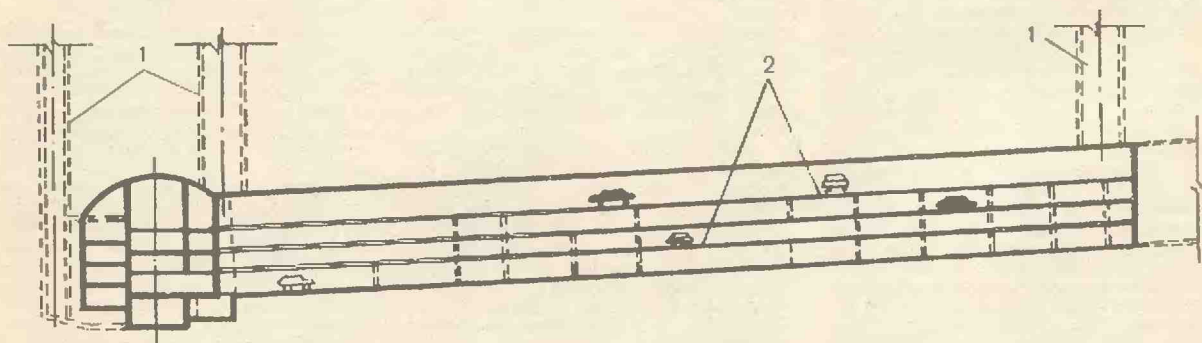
Продольный разрез и поперечное сечение подземного гаража в Леонберге: 1 - шахтные стволы; 2 - места для стоянки автомобилей.
